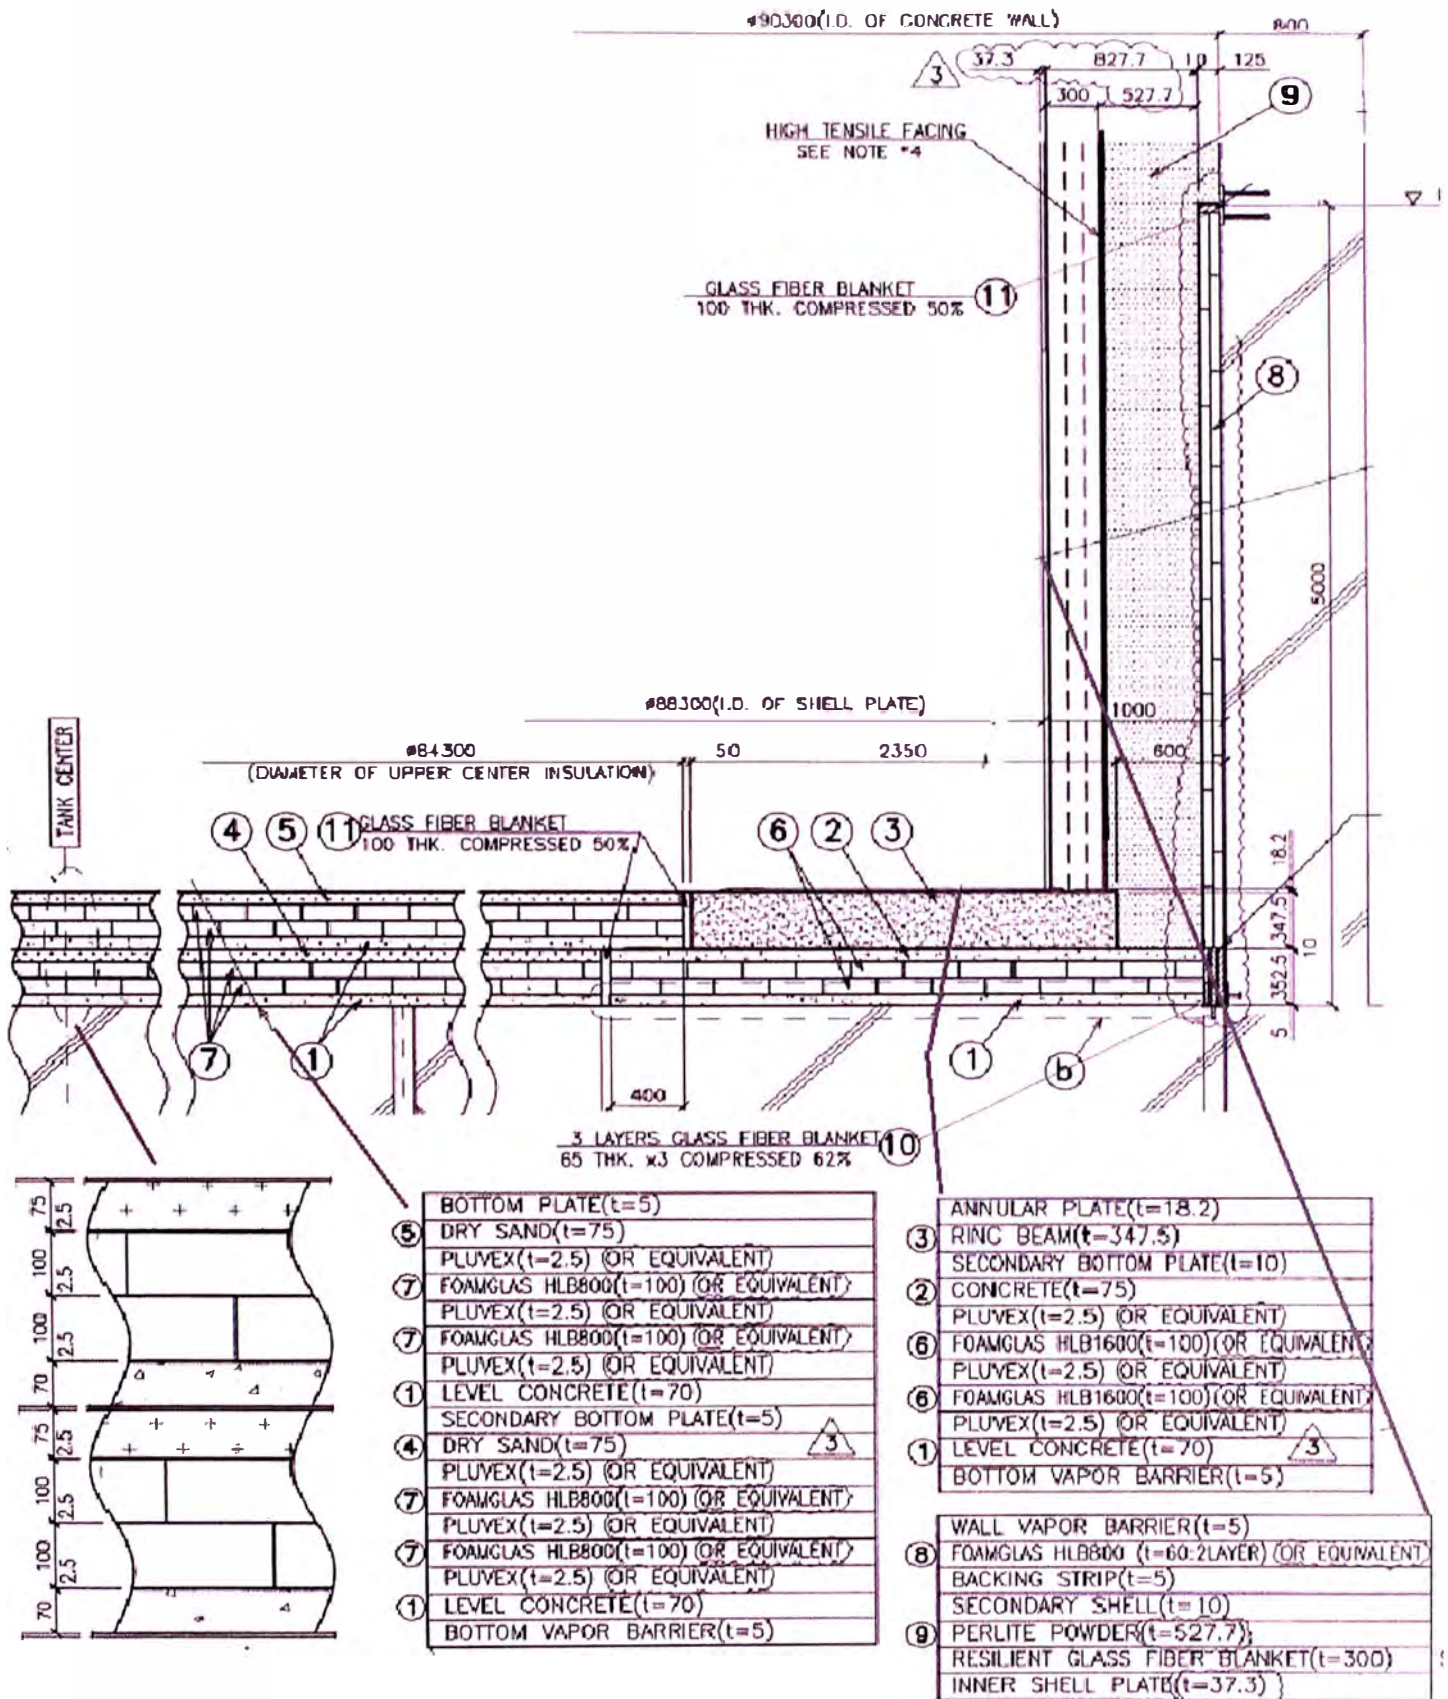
DETALLE DE AISLAMIENTO DE FONDOS
